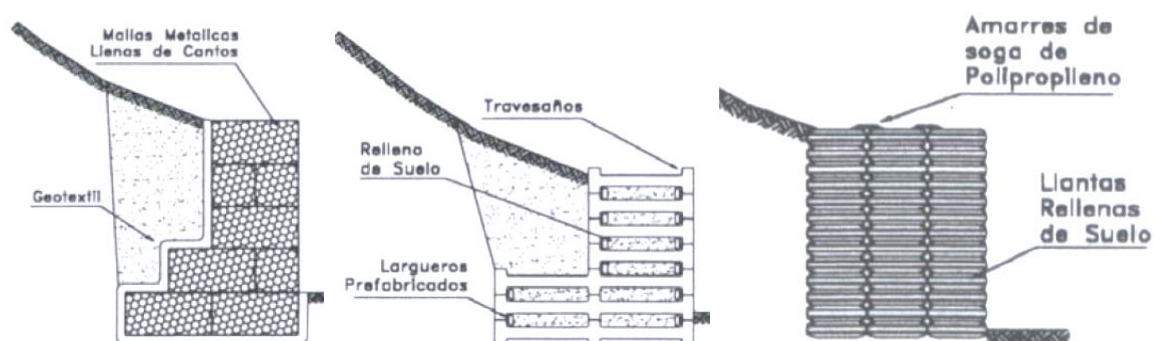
Tipos de estructuras de retención flexibles. Fuente: ACG (2009)
